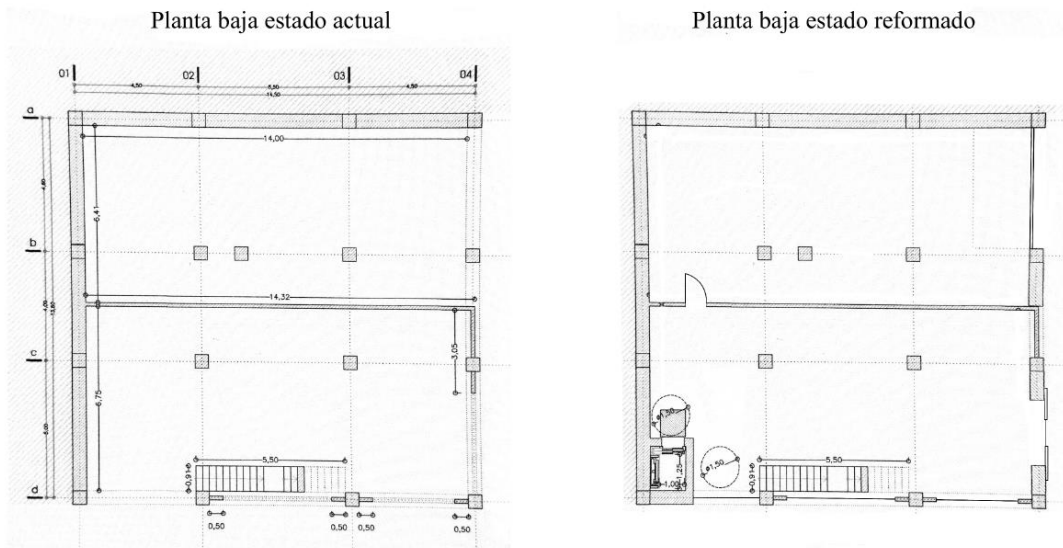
Plano actual y reformado de la planta baja del Lavadero de carbón del Pozo Casares en Tremor de Arriba. Fuente: plano del estado actual: Francisco De Borja Menéndez y Paula Núñez Álvarez, «Proyecto de rehabilitación del Lavadero Casares para Centro temático de la miel en Tremor de Arriba», 2024, Archivo del Ayuntamiento de Igüeña; plano estado reformado: reelaboración propia.
